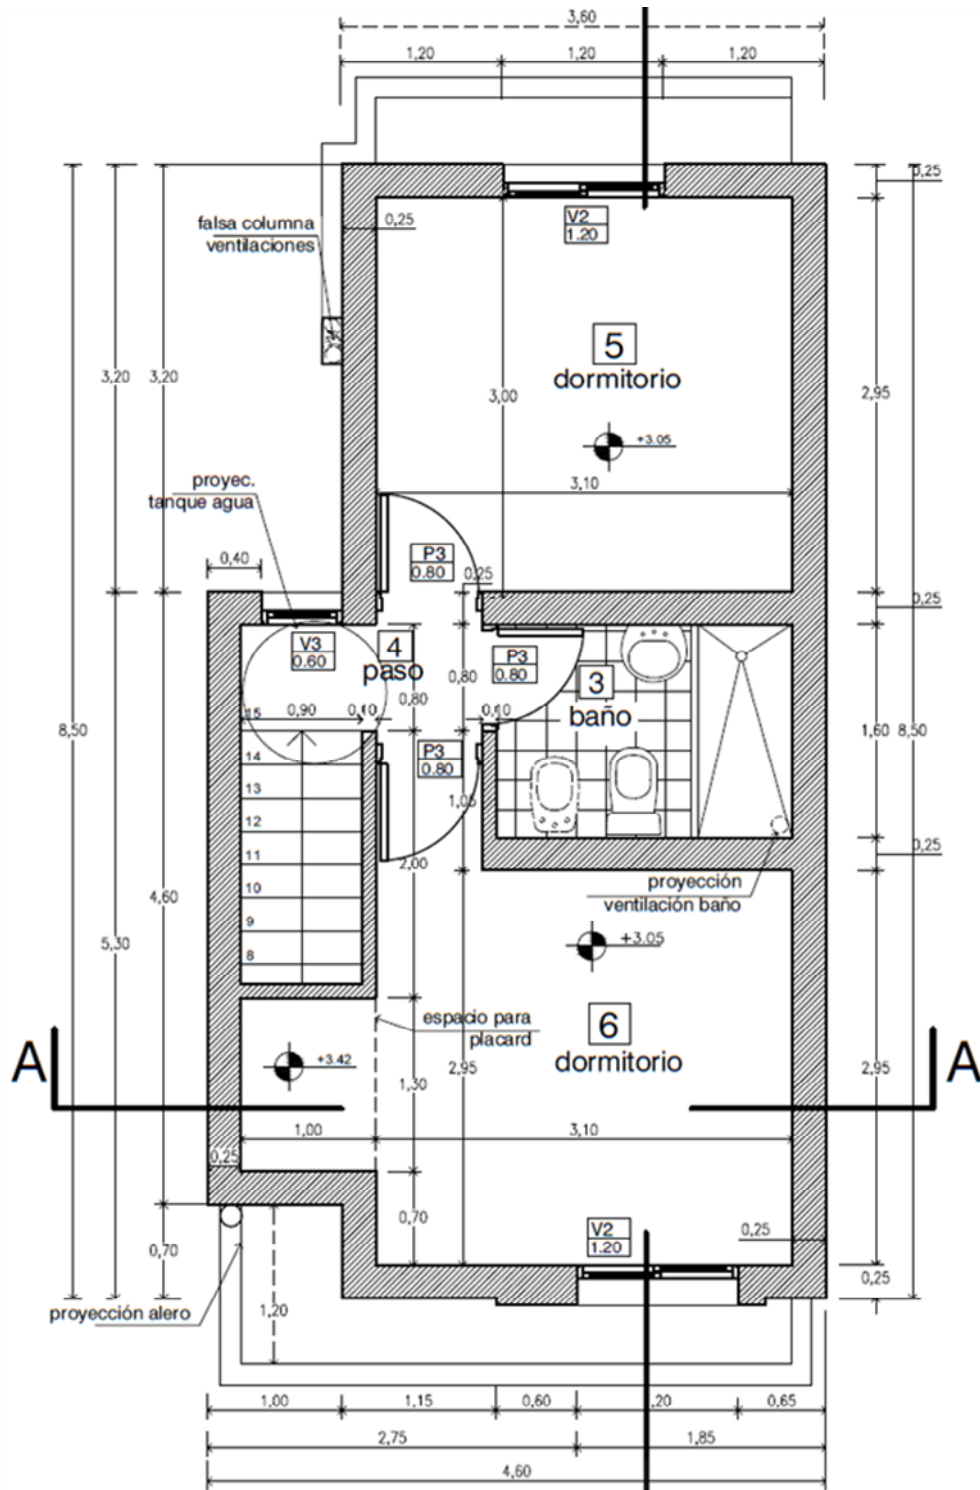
Planta alta de arquitectura de la vivienda de dos plantas.
